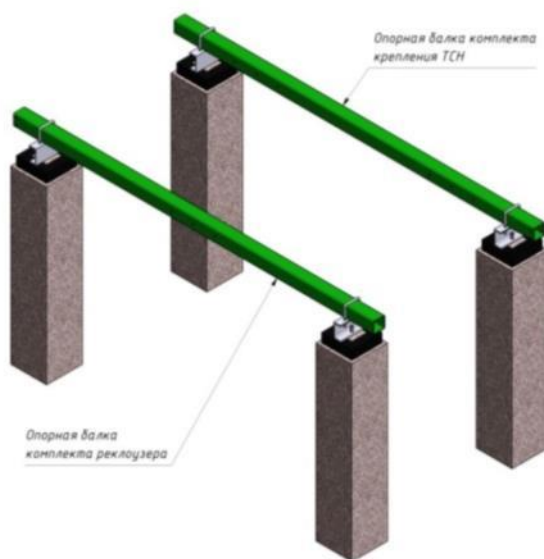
Крепление опорной балки к кронштейнам. Установка на ПС 35/6(10)кВ
